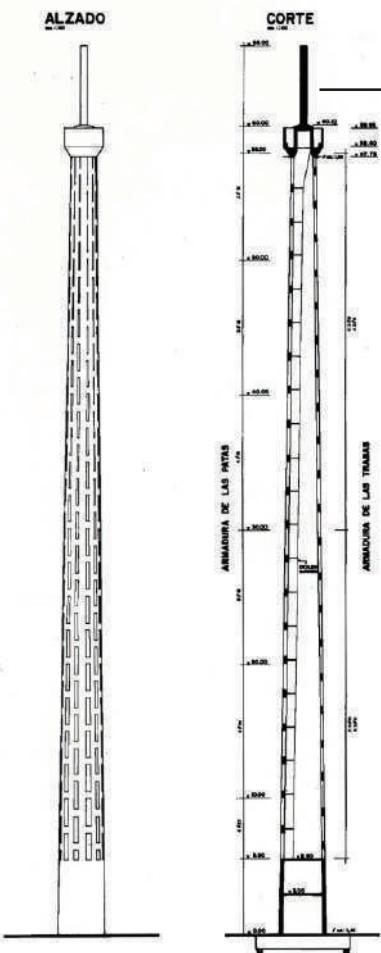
Vista e corte da torre de 66 m. de altura. (*-1).
